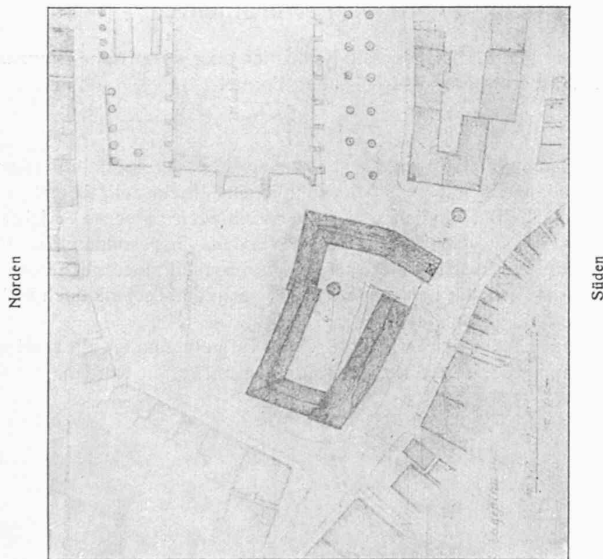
Entwurf „Barfässer Hof“. — Lageplan 1 : 2600.
